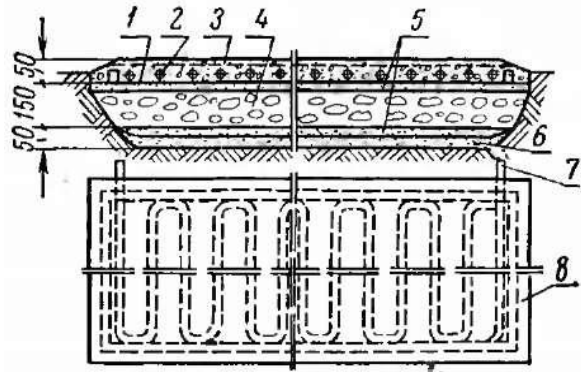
Будова електричного обігріву підлоги з нагрівальним дротом: 1 – бетонна підлога; 2 – нагрівальний дріт; 3 – екранна металева сітка; 4 – теплоізоляція; 5 – пісок; 6 - гідроізоляція; 7 – виходи нагрівального дроту; 8 – дерев'яна рама.
